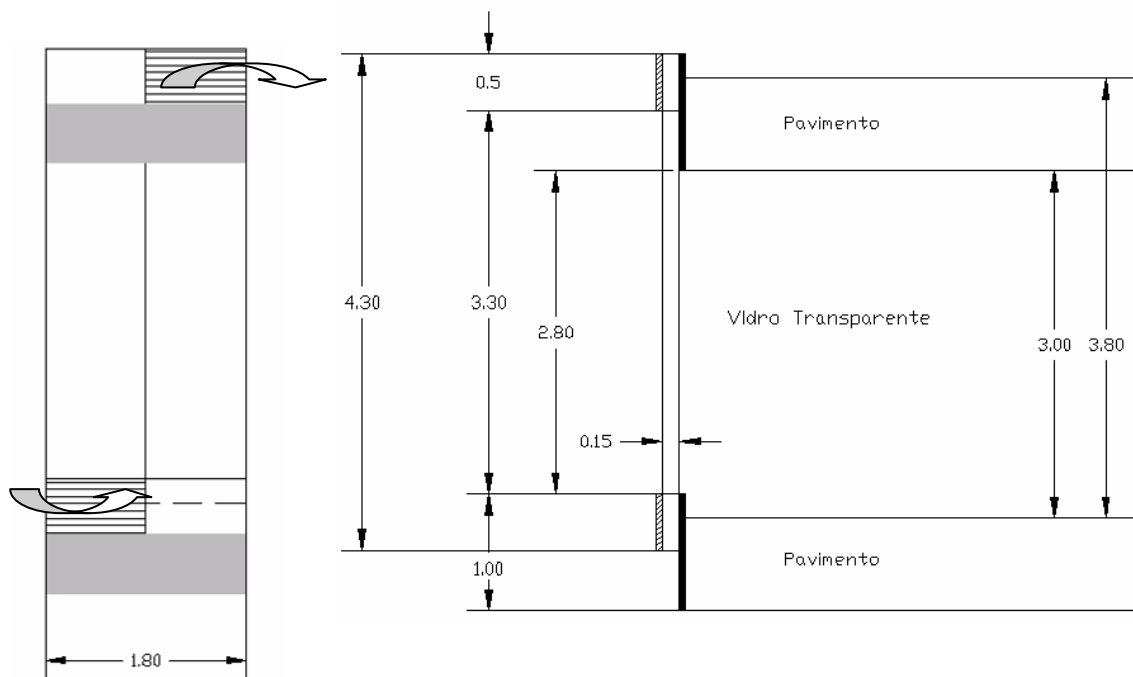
Alçado e secção de um módulo da fachada dupla-pele
